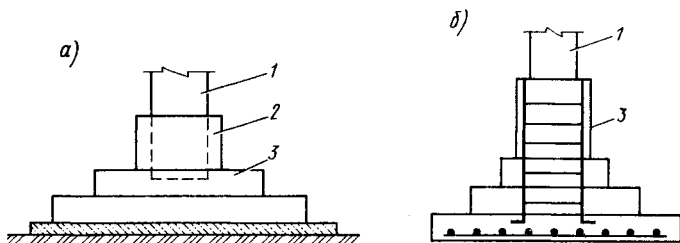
Конструкции монолитных железобетонных фундаментов:
